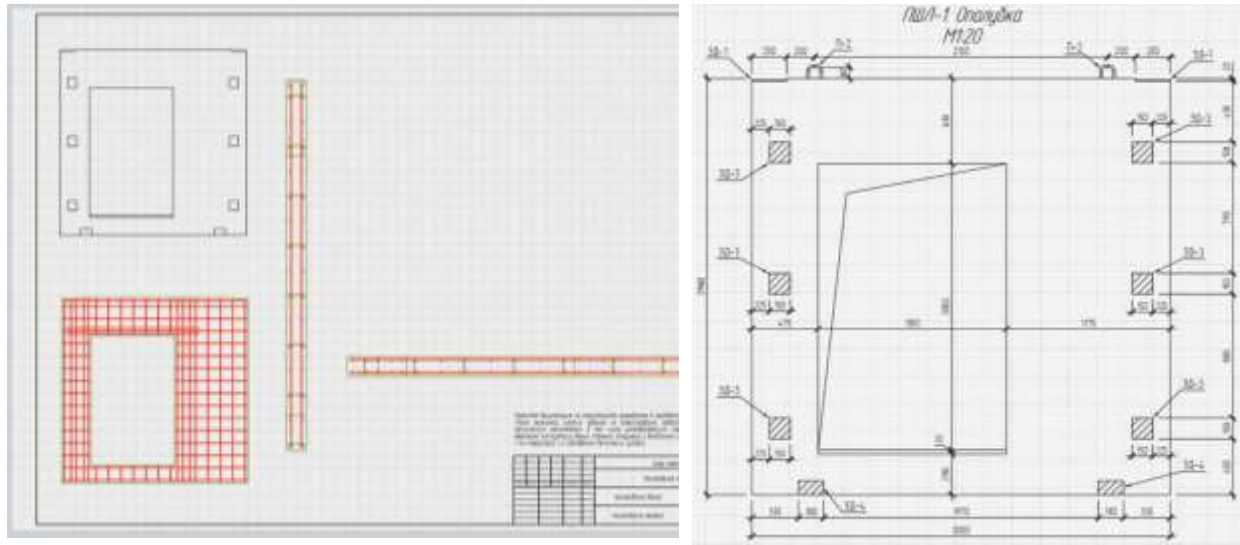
Чертеж. Все виды. Готовая опалубка
